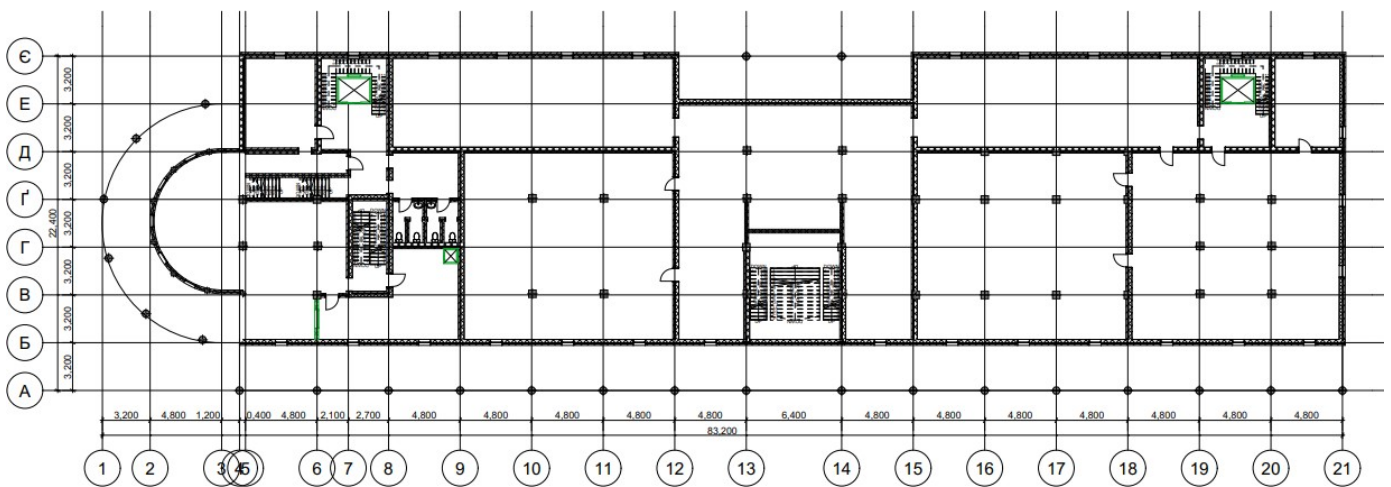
План 2 поверху з монтажем стінових конструкцій
